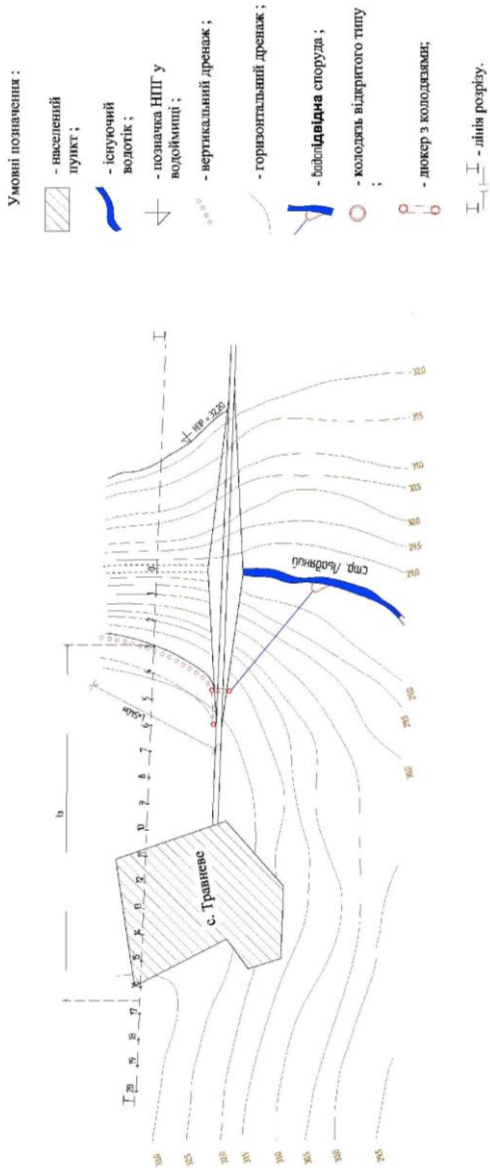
Розташування горизонтального та вертикального дренажу на плані
